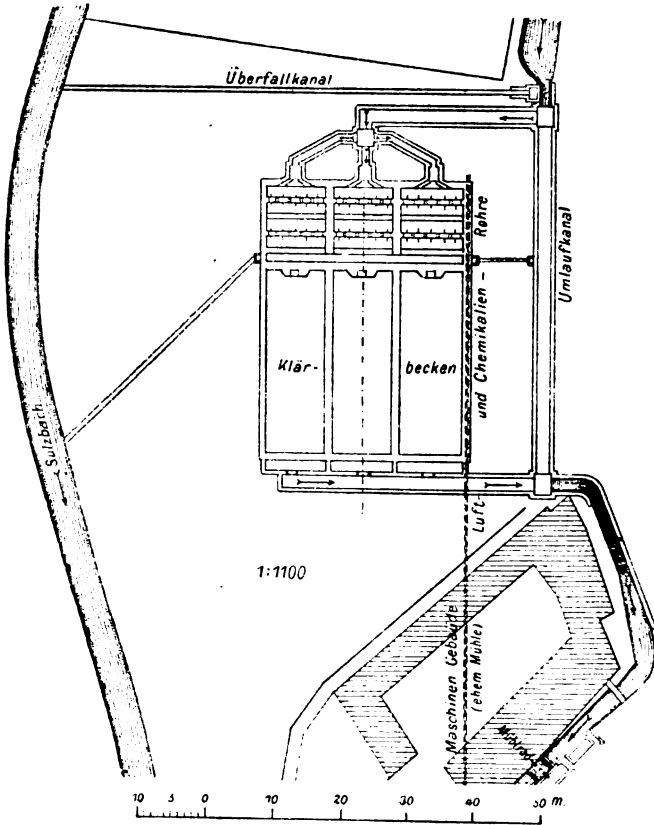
Situationsplan der Klärbeckenanlage in Wiesbaden.
